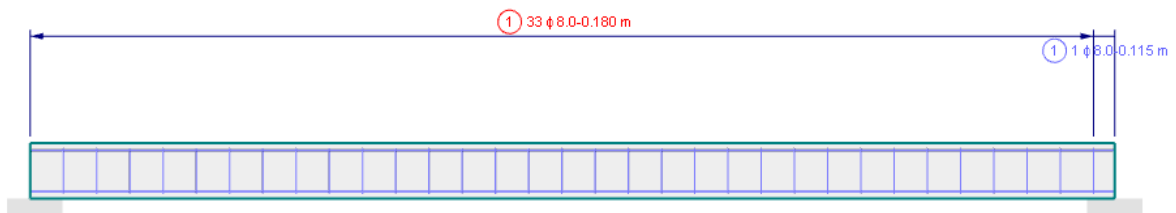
Cantidad de armadura existente en las vigas de atado.
